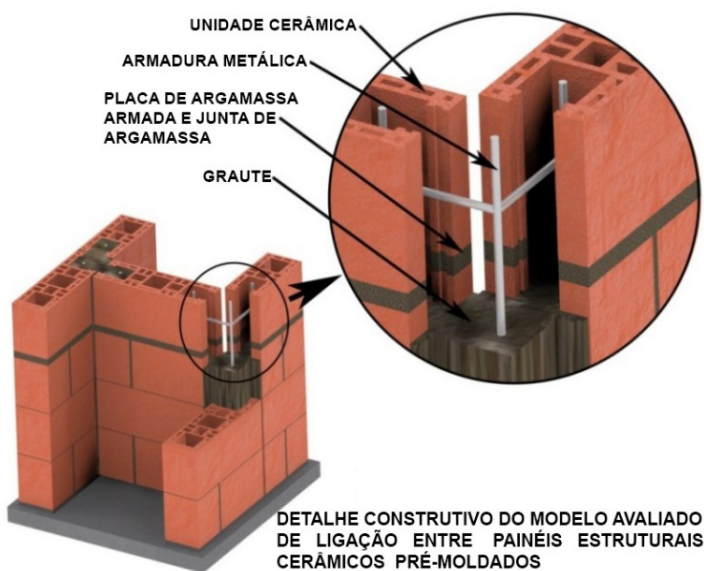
Detalhe construtivo do modelo avaliado de ligação entre painéis estruturais cerâmicos pré-moldados. Fonte: Autor.
